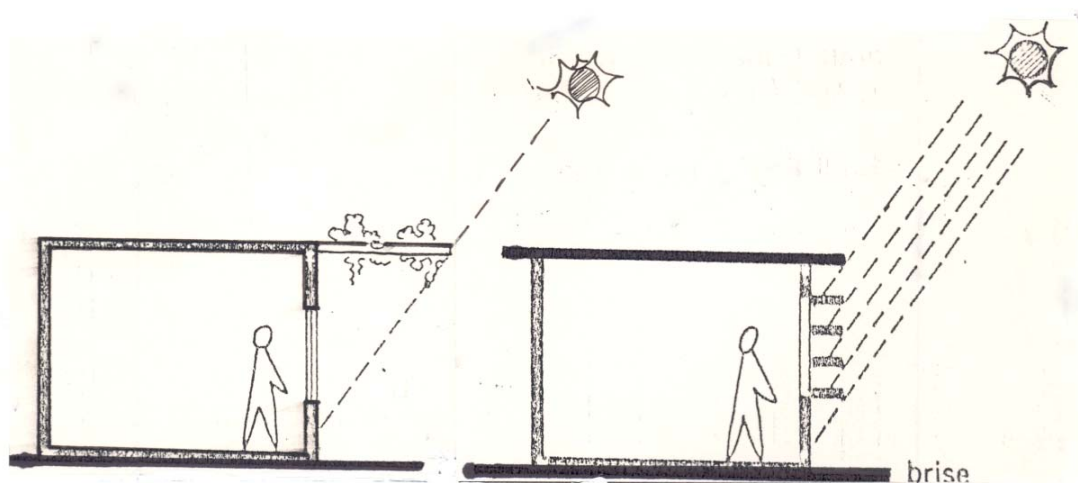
Dispositivos de proteção horizontal (ROSA, L. Z., 1991)
